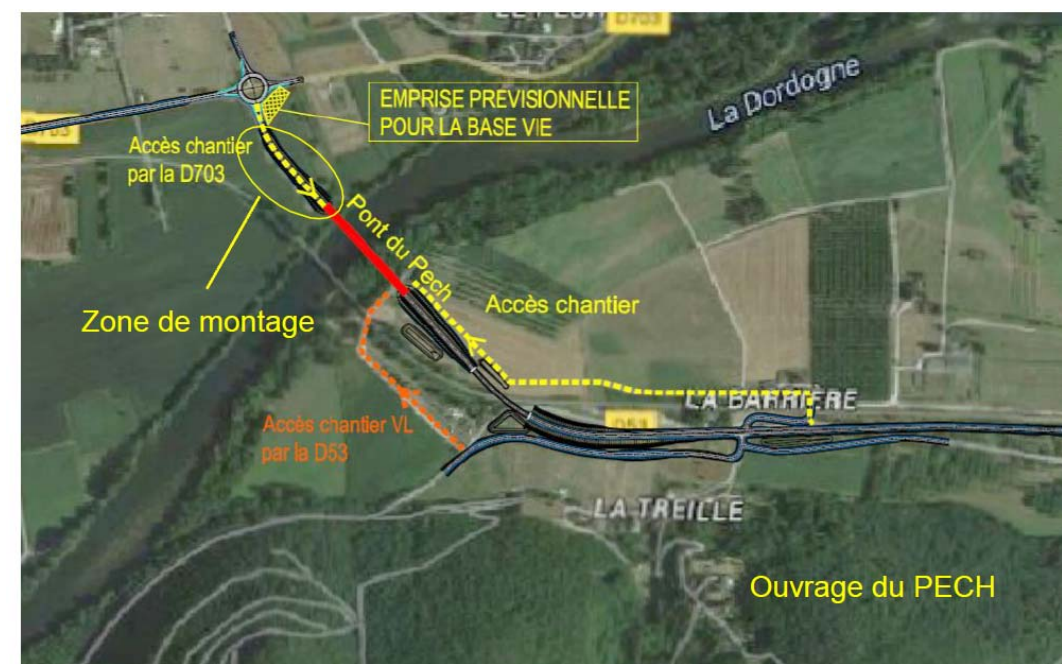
Plan d'implantation de la zone de montage et des accès chantier pour l'OA du Pech (Source : setec tpi, juillet 2016)
